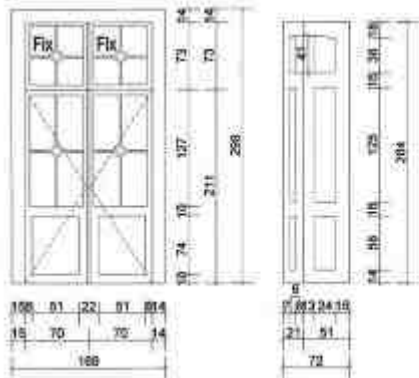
10 Detail B West, Süd, Ost, Nord Ansichten
